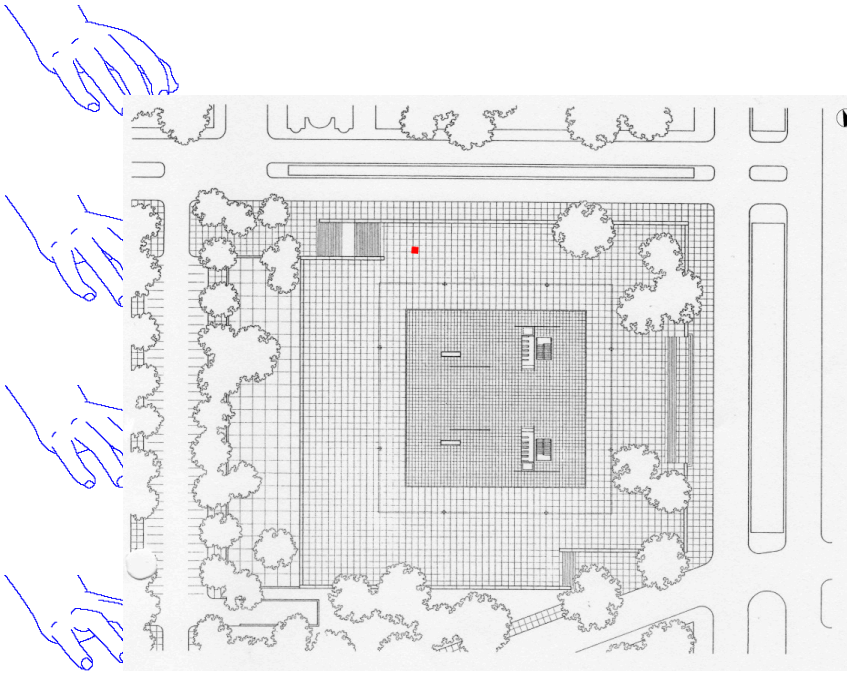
Mies van der Rohe, Neue Nationalgalerie, Grundriss des Erdgeschosses mit eingezeichnetem Berlin Block (for Charlie Chaplin), 1962 - 67, Berlin.
